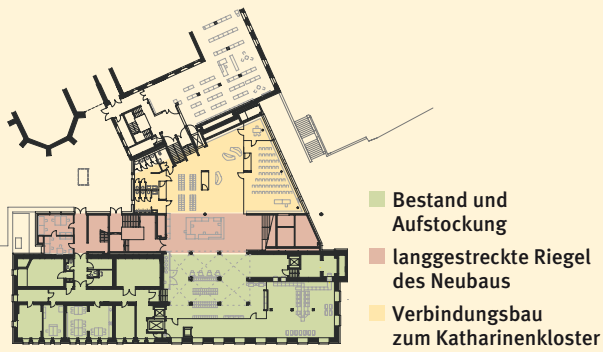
Grundriss Erdgeschoss mit Foyer und Lernwelt
